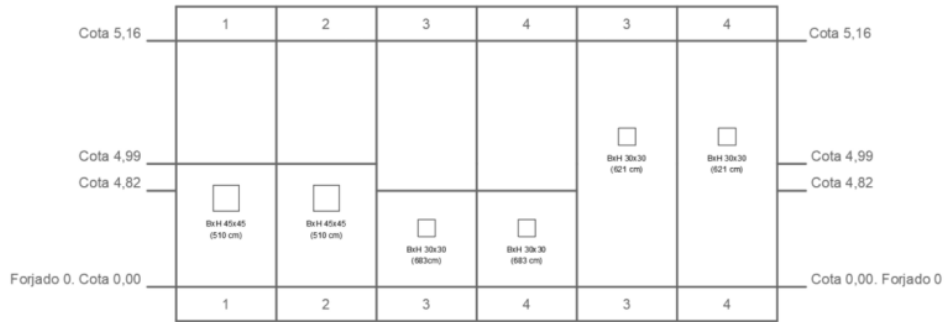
Planta de vigas numeradas con sección de madera, Dibujo propio
